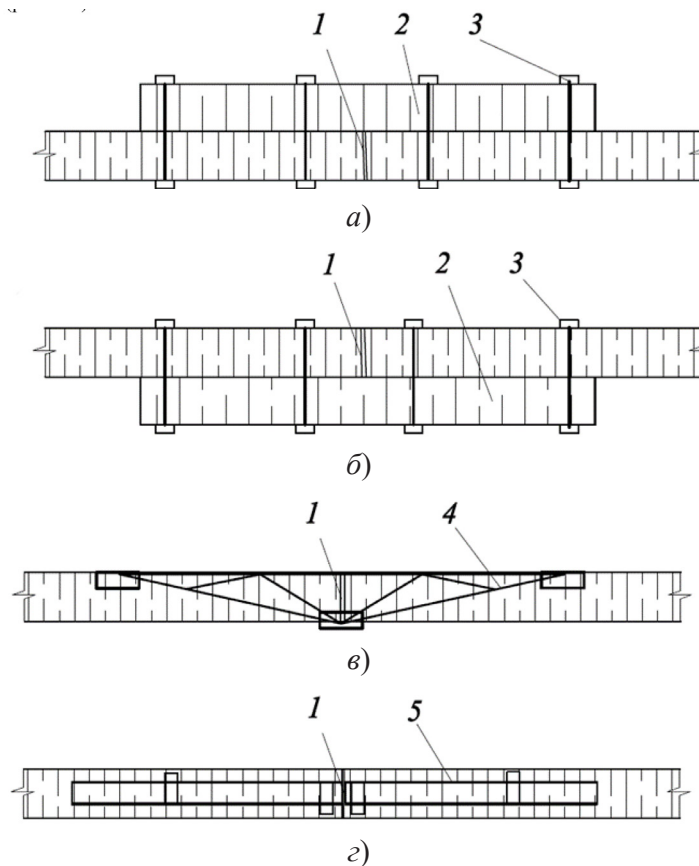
Усиление балок в пролете протезами: *а, б* – из деревянных накладок соответственно сверху и снизу; *в* – стальными прутковыми; *г* – из стальных профилей; *1* – усиливаемая балка с трещиной; *2* – деревянная накладка; *3* – стяжной болт; *4* – протез из арматуры  $\varnothing 16$  мм; *5* – швеллер № 10–16
